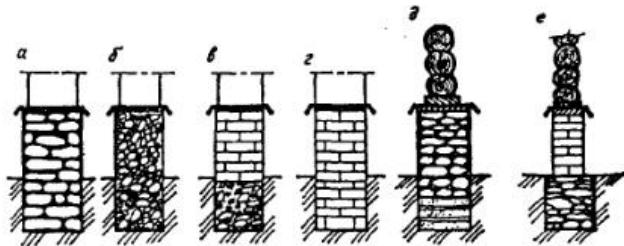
Фундаменты из различных материалов: а — бутовый; б — бутобетонный; в — кирпичный по бутобетону; г — кирпичный; д — бутовый по песчаной подушке; е — кирпичный по буту.
